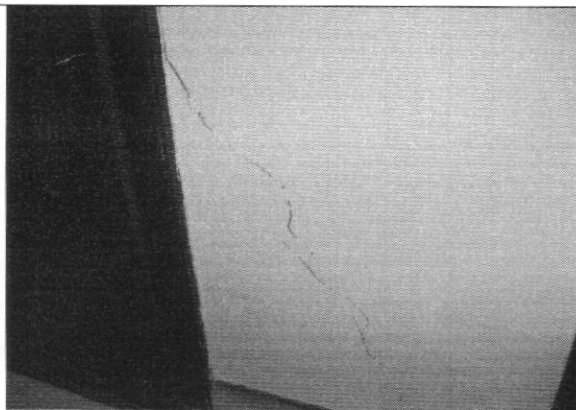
Grietas en parte inferior de muro primer piso
